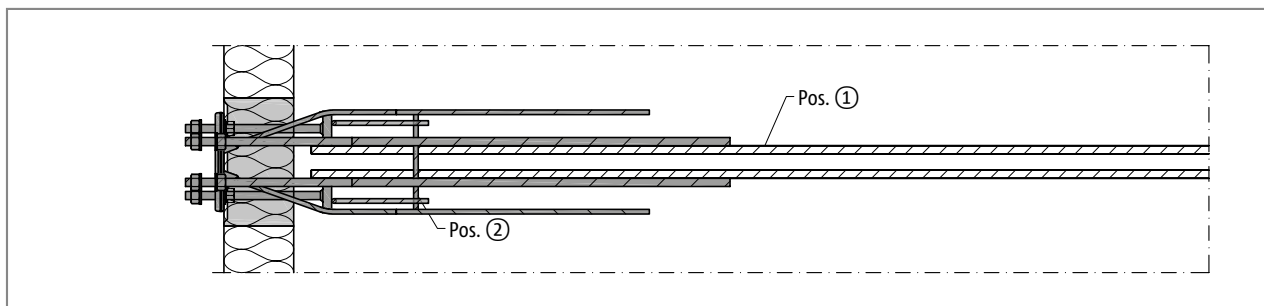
Schöck Isokorb® Typ KSXT14: Bauseitige Bewehrung, Grundriss
